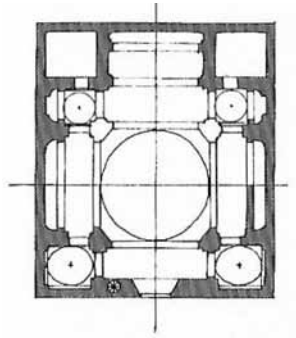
Olocau del Rey (Castellón). Ermita de San Marcos. Planta (Arturo Zaragozá)
